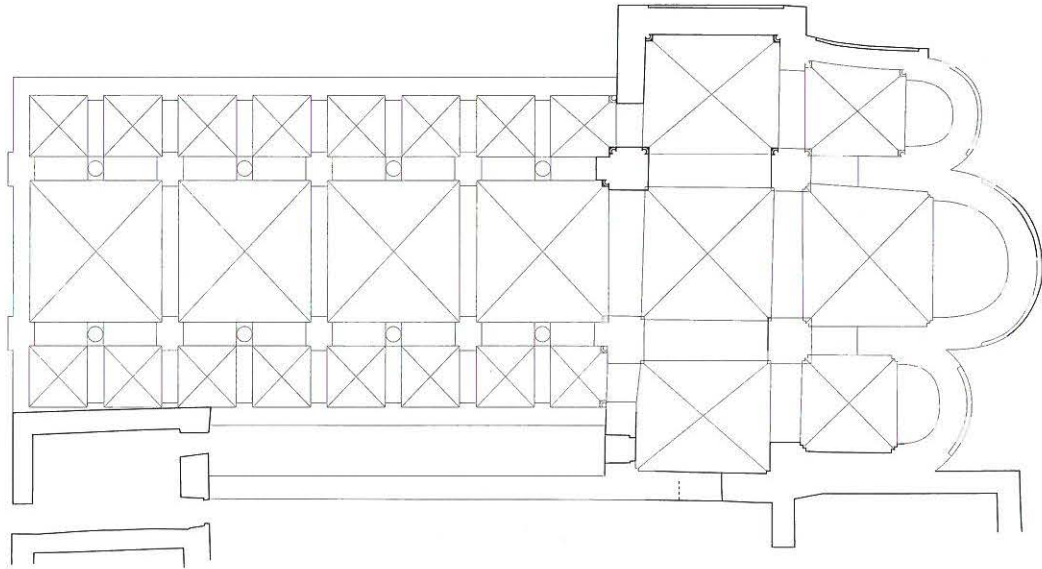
Rekonstruierter Grundriss Basilika II. Schiff nie ausgeführt. M 1:300.
